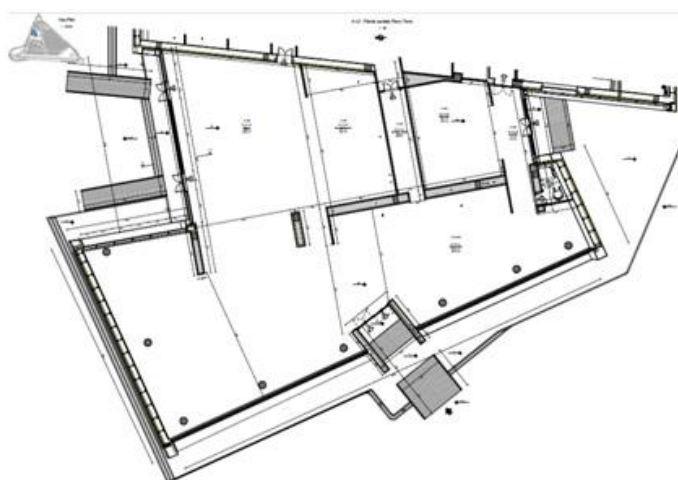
Pianta pianoterra del complesso immobiliare in progetto
